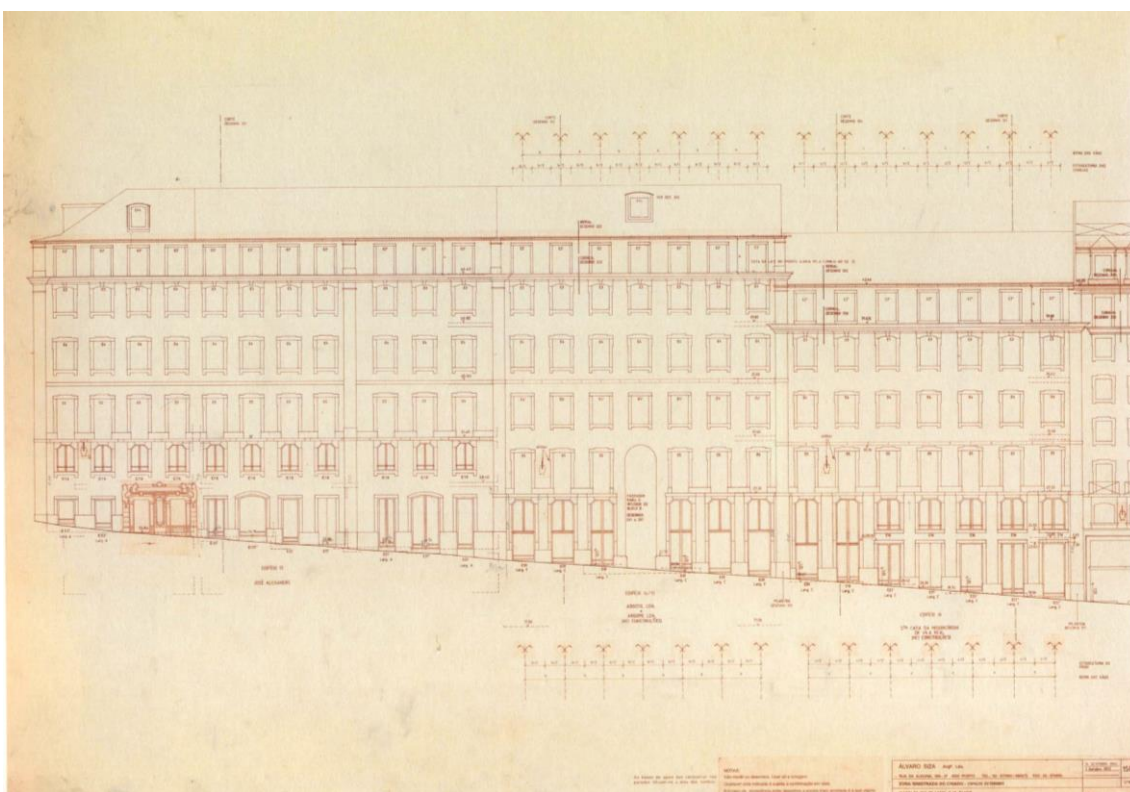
VIEIRA, Siza, *Reconstrução da zona sinistrada do Chiado*, Lisboa, 1988/98. Alçados da rua do Carmo (lado poente). Desenhos sem escala.
